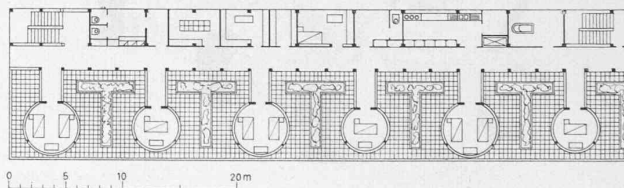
Beobachtungsstation mit runden Krankenzimmern (als Dachgeschoss eines Gross-Krankenhauses), 1 : 600. Entwurf F. LOEWIG
